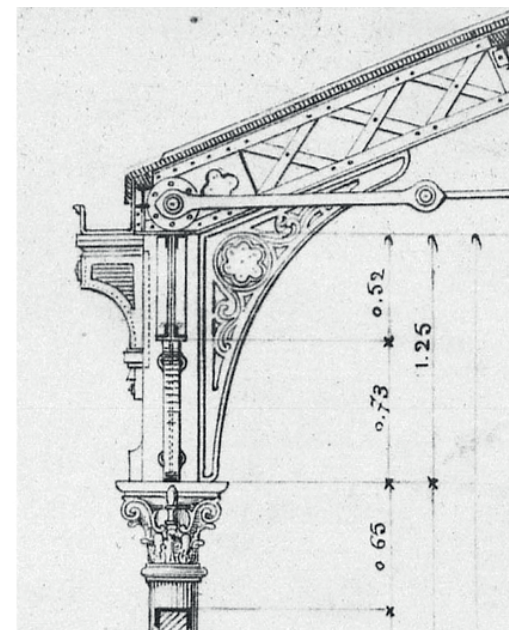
Plano original detalle constructivo encuentro cercha-soporte
